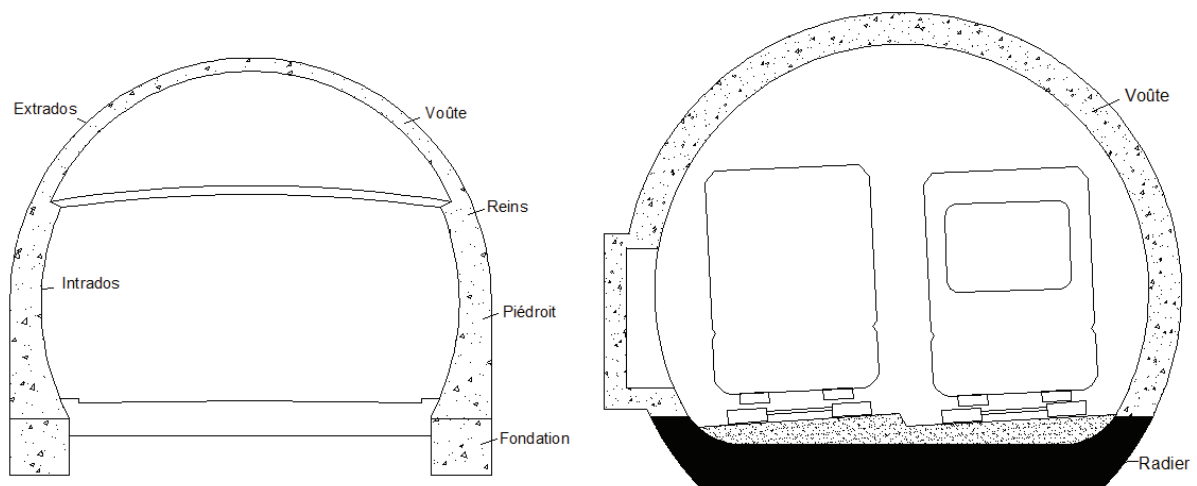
Exemples de profils de tunnels routiers et ferroviaires
